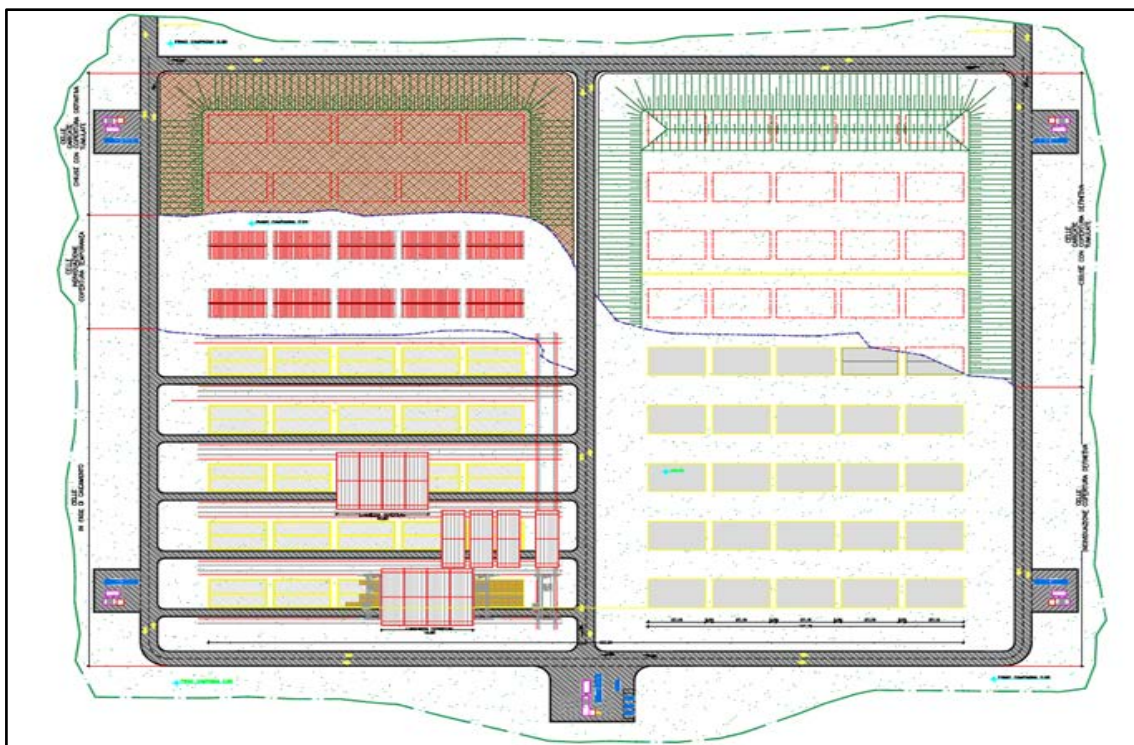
USM: Stralcio Planimetrico con 90 CdD
